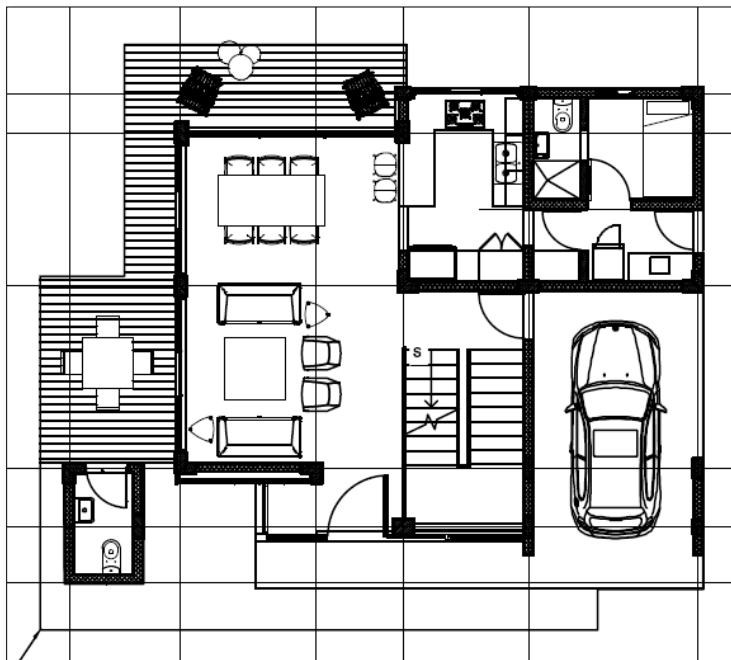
Planta arquitectónica 1er. Nivel. No a escala.
